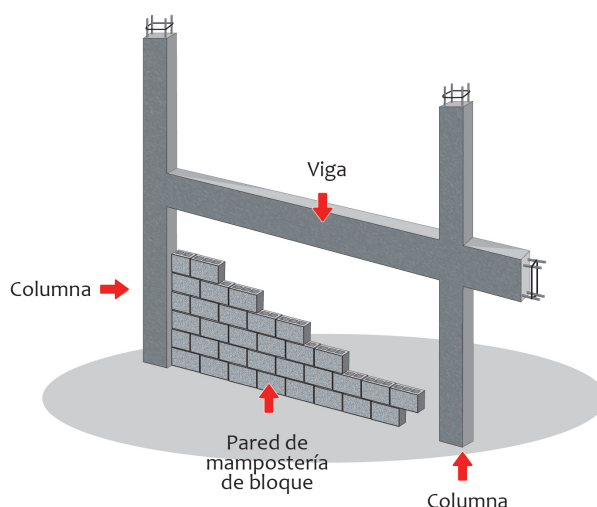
Muro no estructural: paredes de mampostería se construyen luego de columnas y vigas
